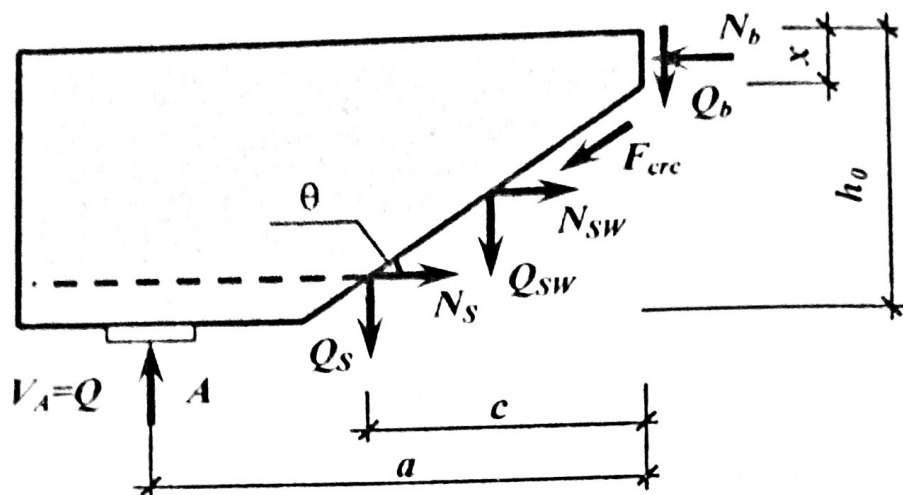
Полная расчетная схема внутренних усилий в наклонном сечении железобетонного элемента без отогнутых стержней метода предельного равновесия.
